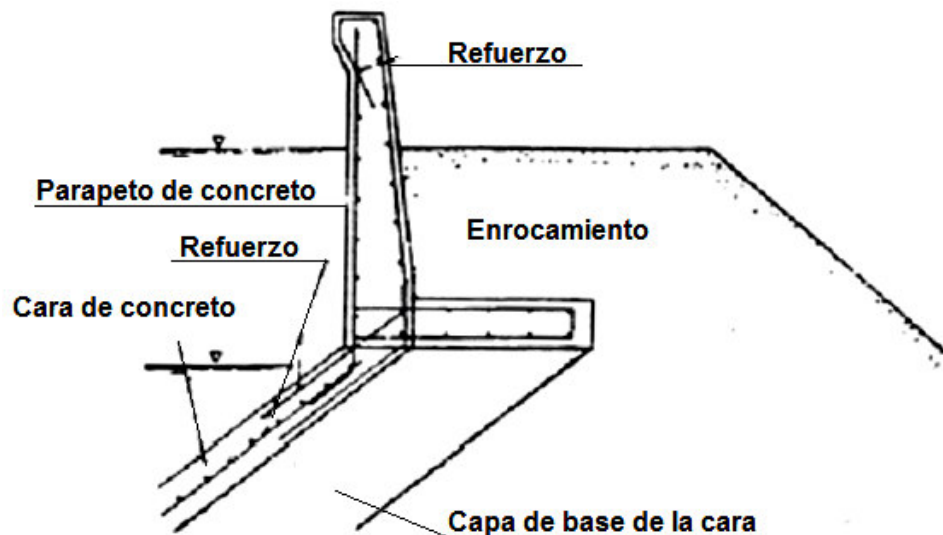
ESQUEMA DE PARAPETO PARA PRESAS DE ECC, (WATERPOWER, 1990)
